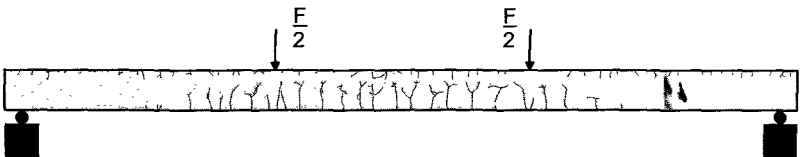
Rissbild Balken G04 nach dem Biegeversuch im Gebrauchslastbereich
